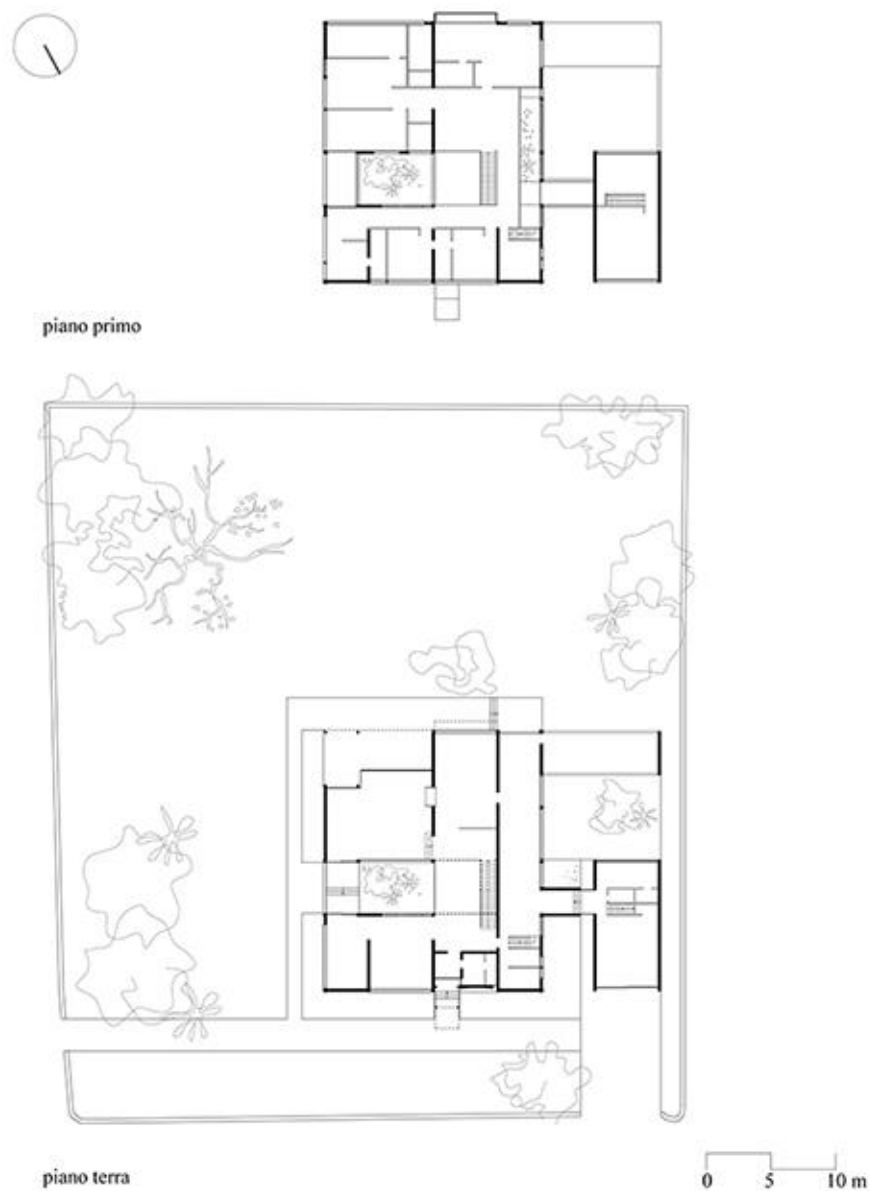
Planimetrie del piano terra e primo. (Elaborazione grafica dell'autore)
